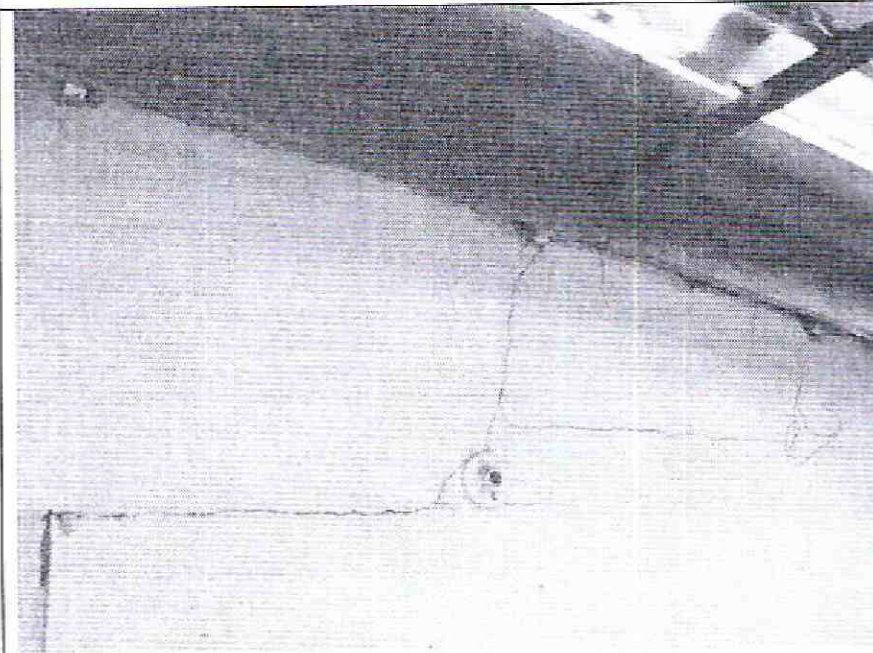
Grietas, daño severo de muro de segundo piso.
